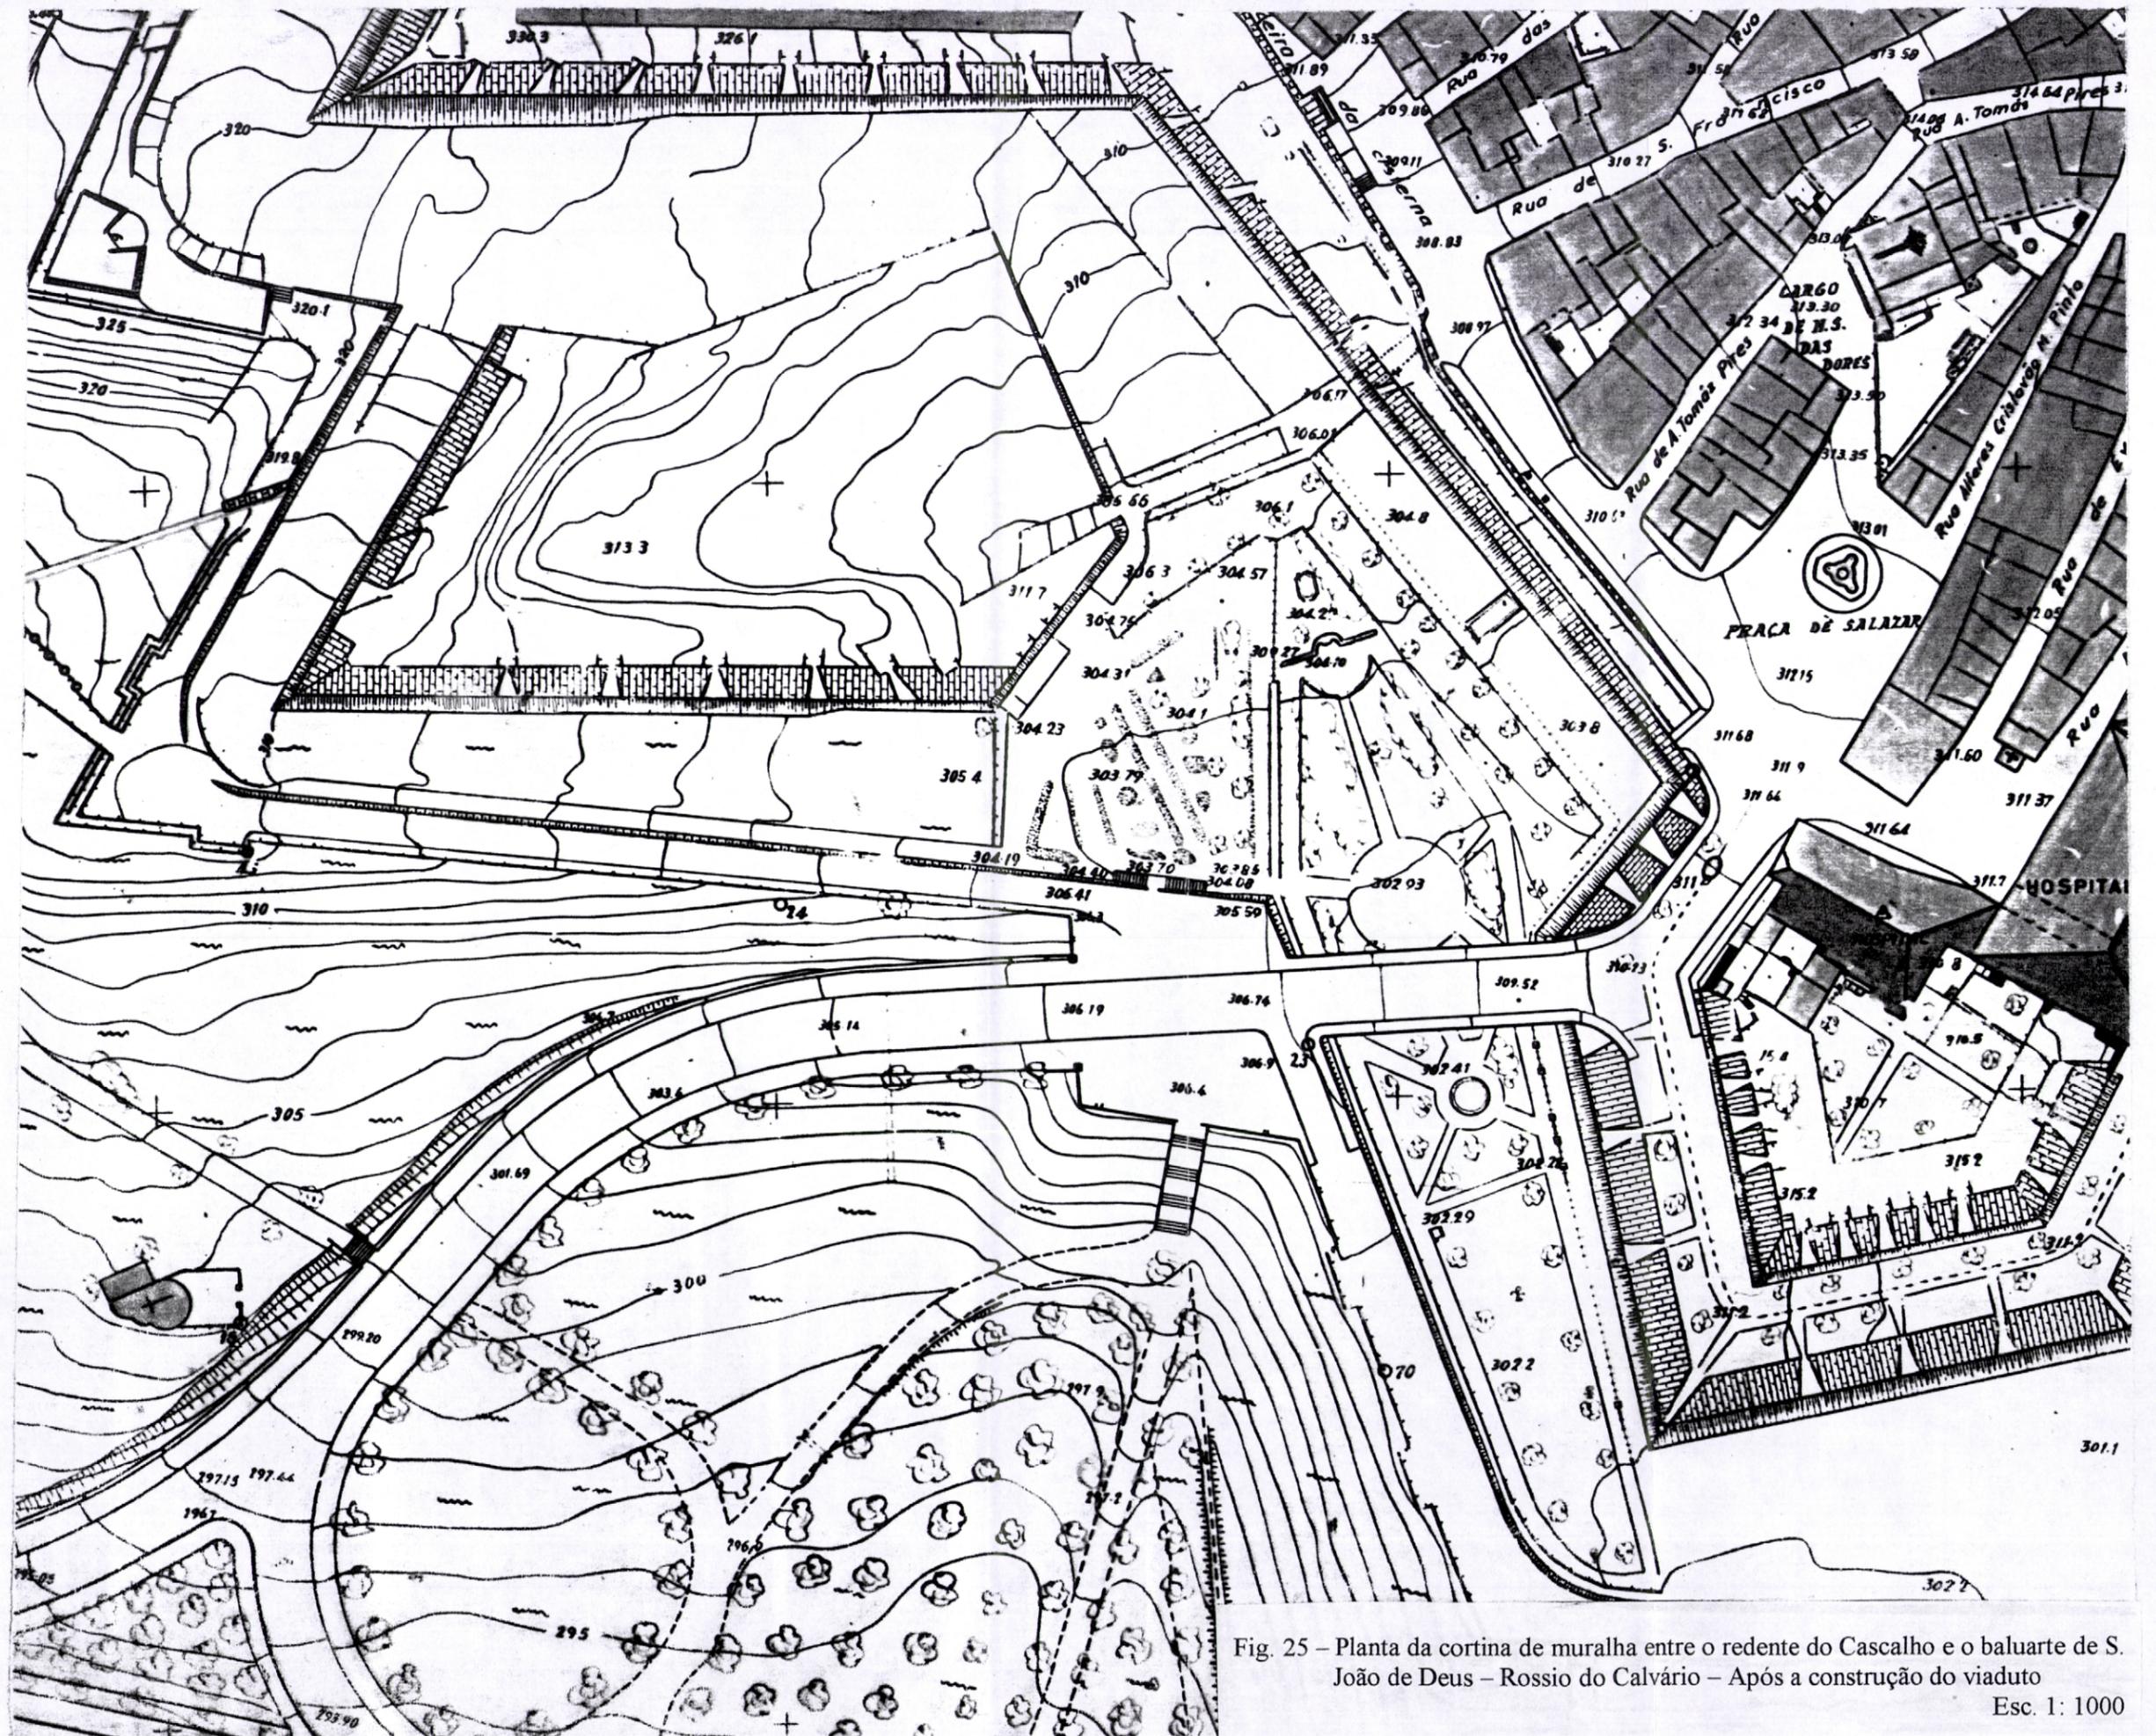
Planta da cortina de muralha entre o redente do Cascalho e o baluarte de S. João de Deus – Rossio do Calvário – Após a construção do viaduto
